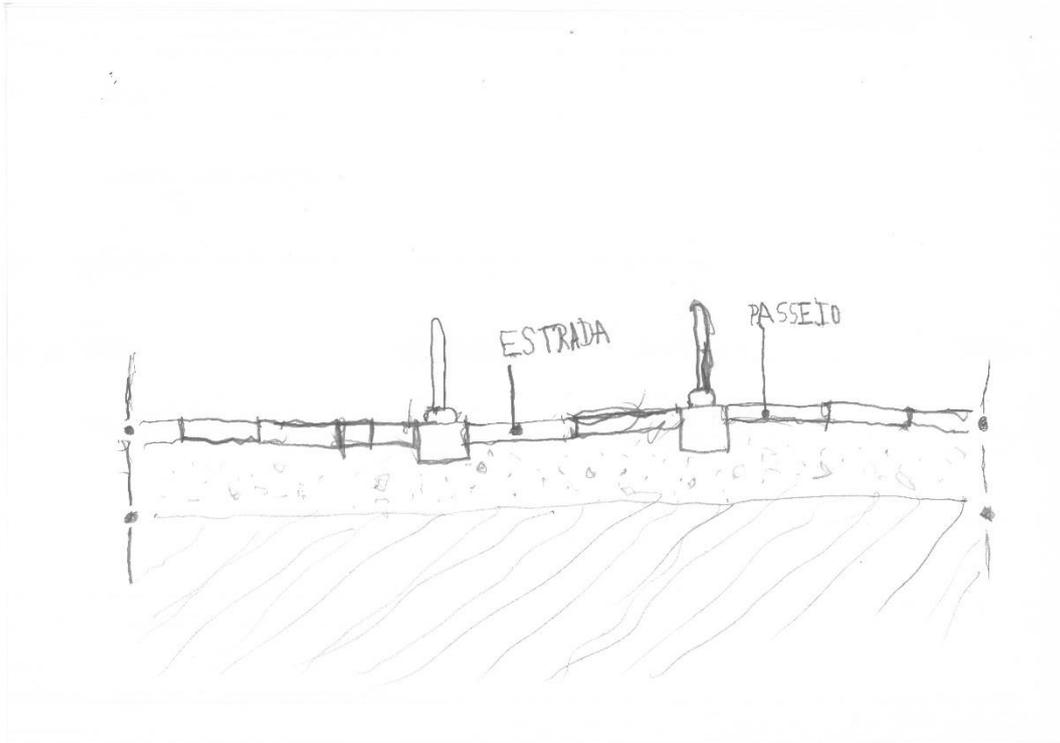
Esquízo de pormenor 1 do pavimento do espaço público do bairro da Parcela 6, em corte
